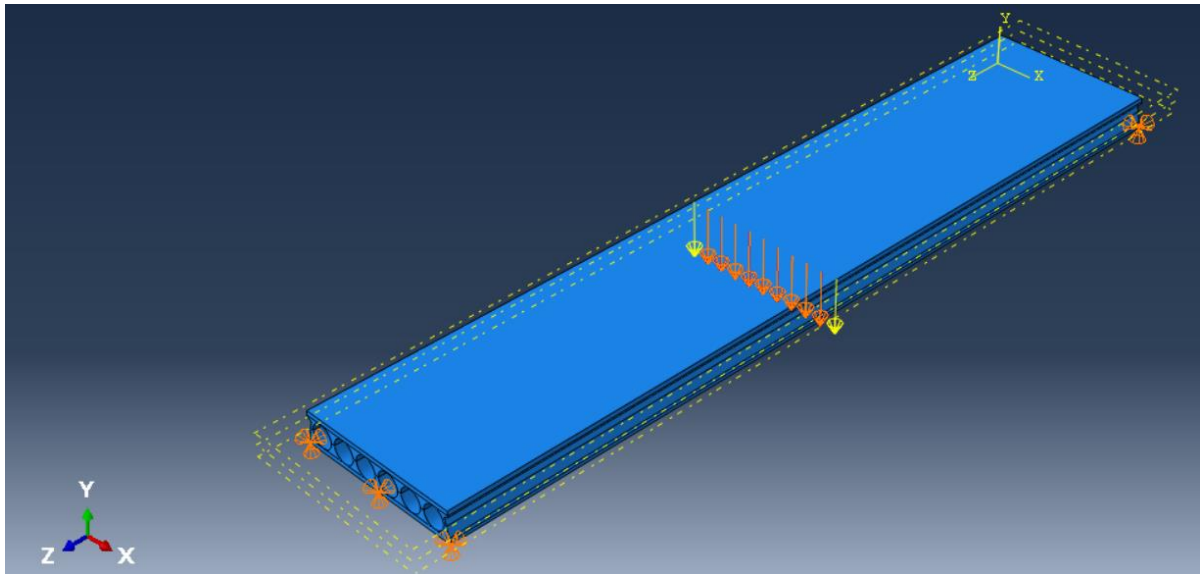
Пустотная плита перекрытий ПК-8-58.12 с заданными нагрузками
